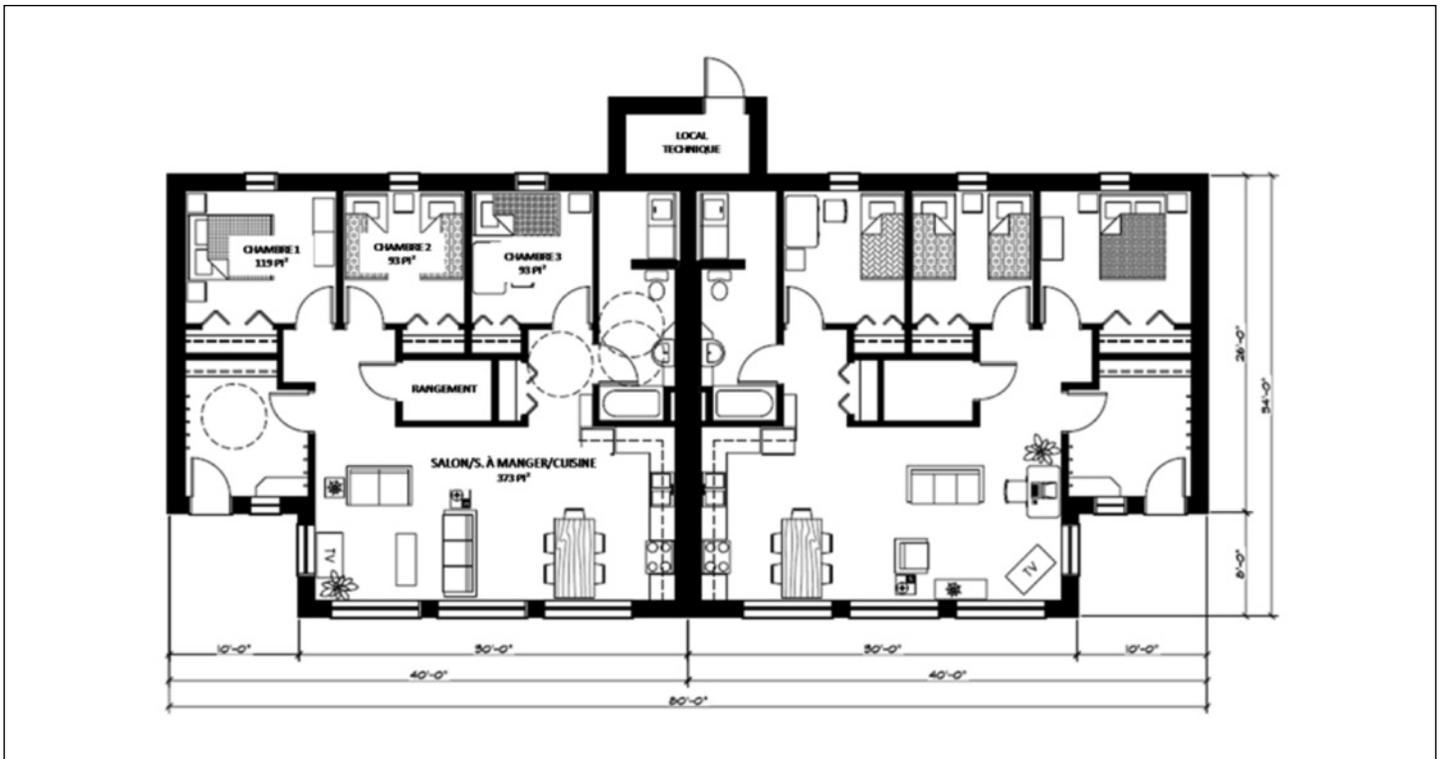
Plan de la Maison durable construite pour le Nord à Inuvik (Source : SHTNO)
